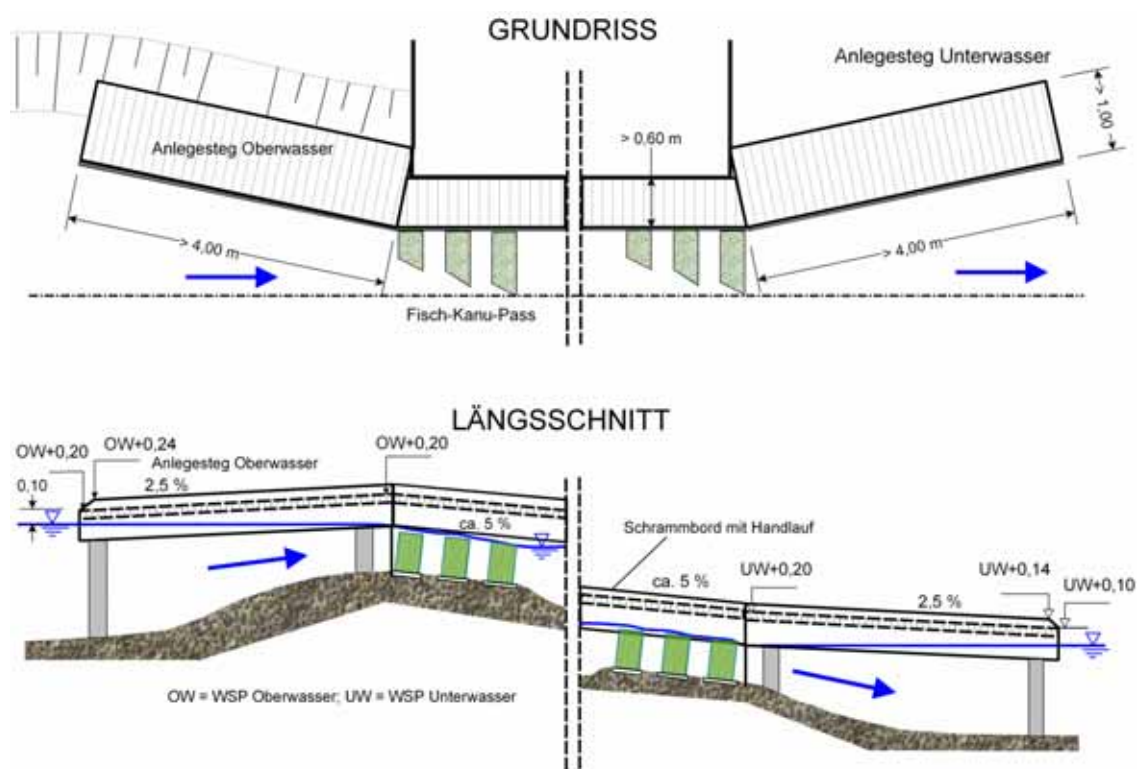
Grundriss- und Längsschnittskizze zur Anordnung eines Treidelstegs
